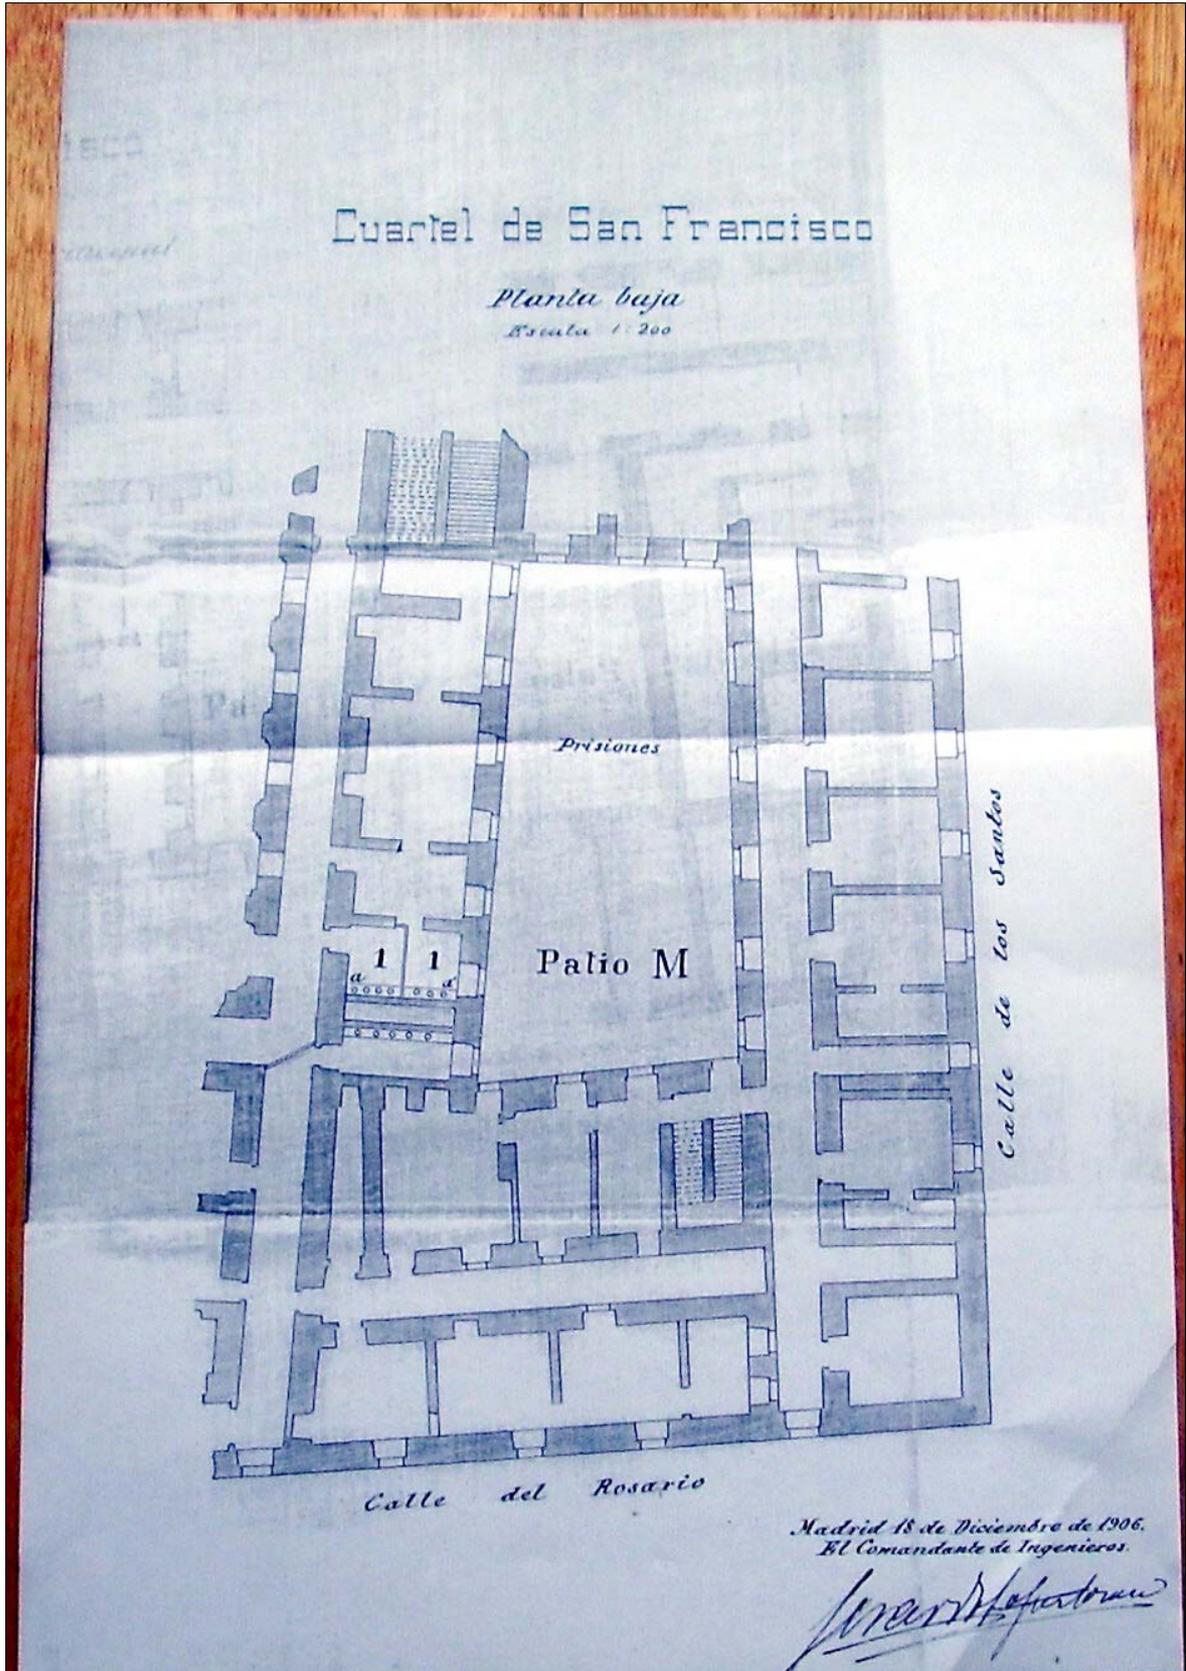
Cuartel de San Francisco. Levantamiento planimétrico del nivel de planta baja de la zona de Prisiones Militares. Escala original, 1:200. Archivo General Militar, Sección 3ª., división 3ª., leg. 580.
